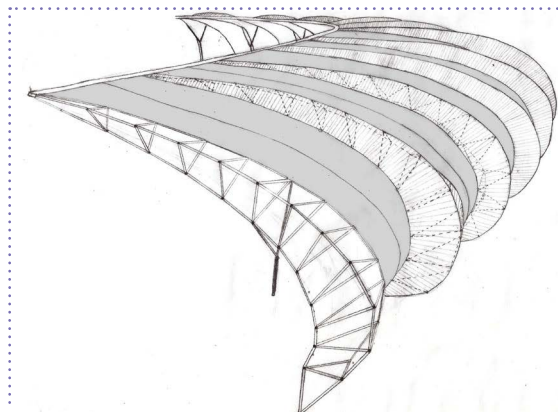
Aspecto exterior de la cubierta del estadio Nelson Mandela Bay
